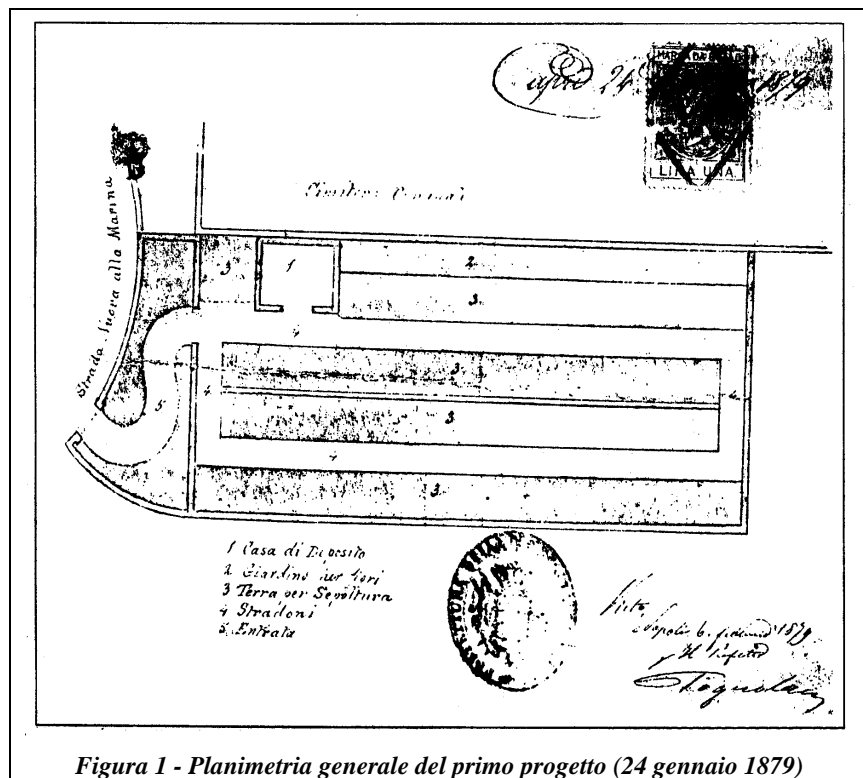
Planimetria generale del primo progetto (24 gennaio 1879)
